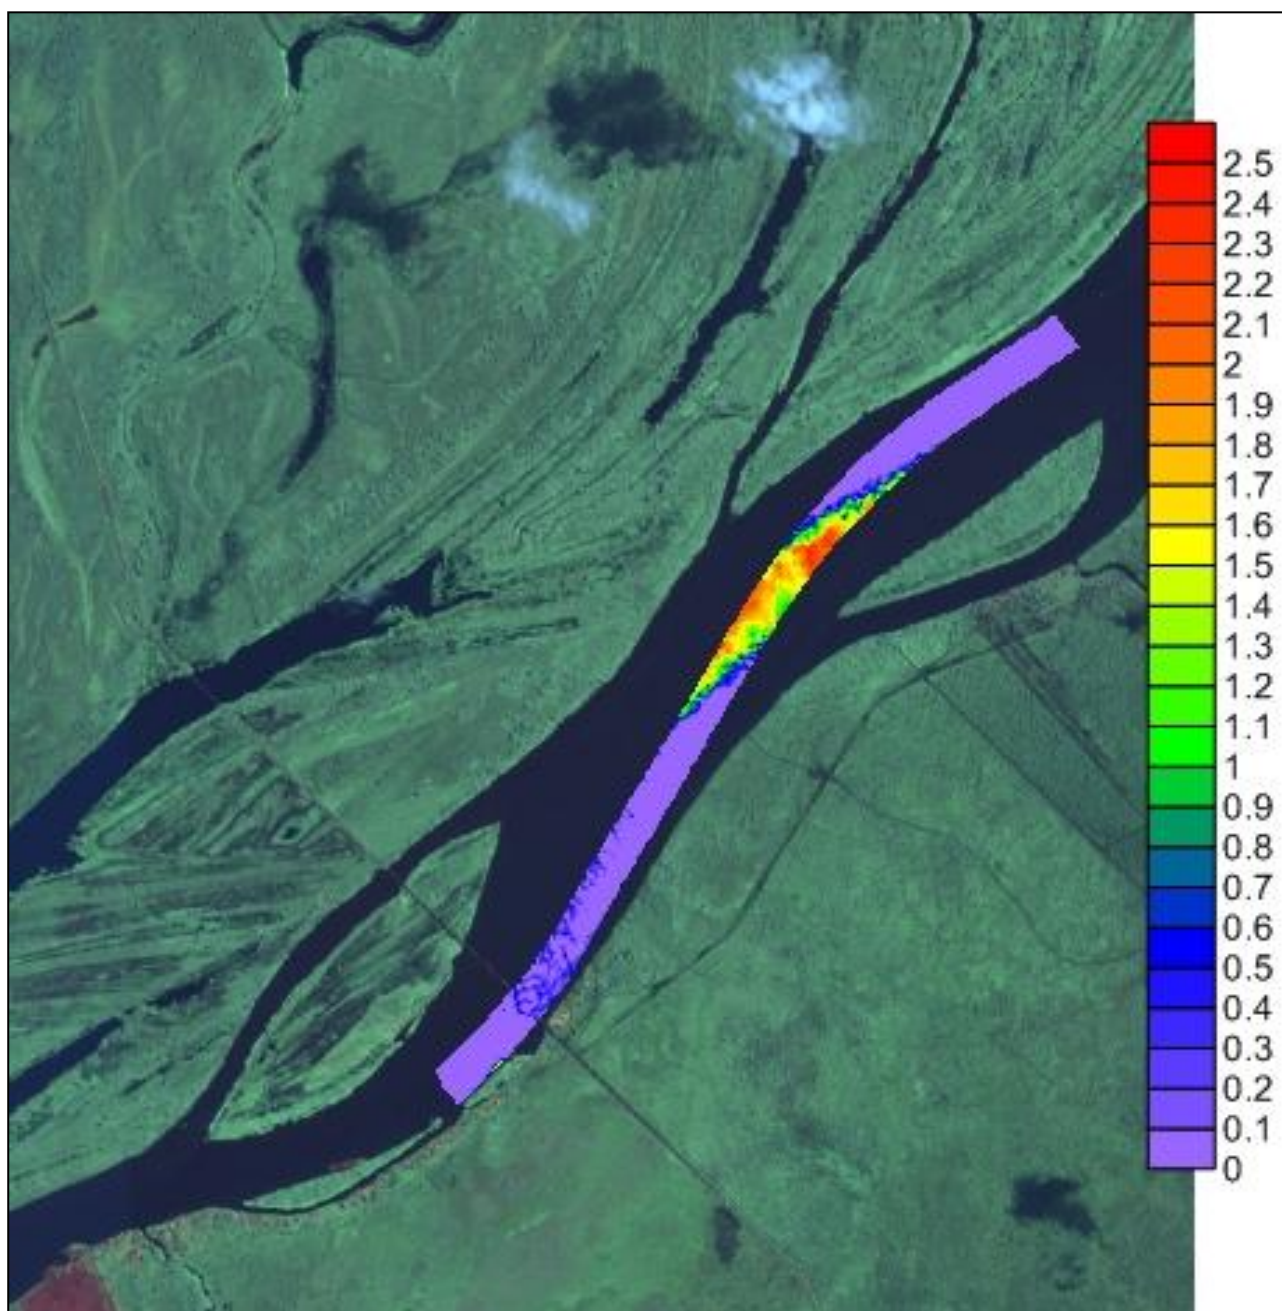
ALTURA (M) A SER DRAGADA AO LONGO DO CANAL DE 180 M DE LARGURA
